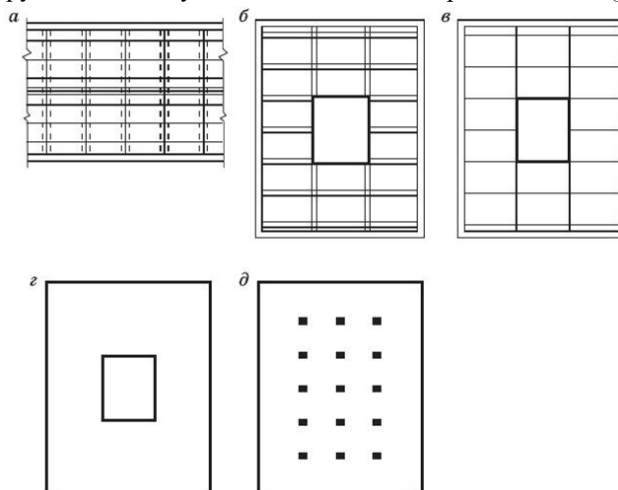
Комбинированные конструктивные системы высотных зданий: а - каркасно-стенная; б - каркасно-ствольная; в - ствольно-стенная; г - оболочково-ствольная; д - оболочково-каркасная; несущие; наружные стены; ненесущие стены; колонны
